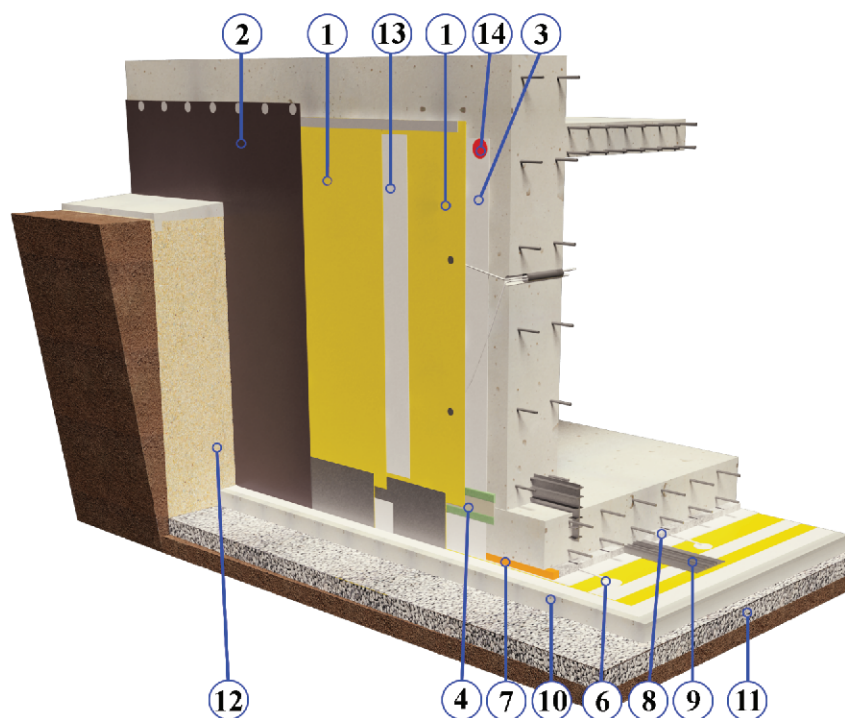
Схема однослойной гидроизоляционной системы при открытом способе строительства с пазухами под обратную засыпку. 1-Гидроизоляция PLASTFOIL®; 2-защитный слой; 3-геотекстиль 500; 4-гидроизоляционная лента; 5-ПЕНОПЛЭКС®; 6-контрольно-инъекционная система; 7-брусек компенсатора; 8-защитная стяжка; 9-гидрошпонка; 10-бетонная подготовка 11-щебеночная подготовка; 12-обратная засыпка.
